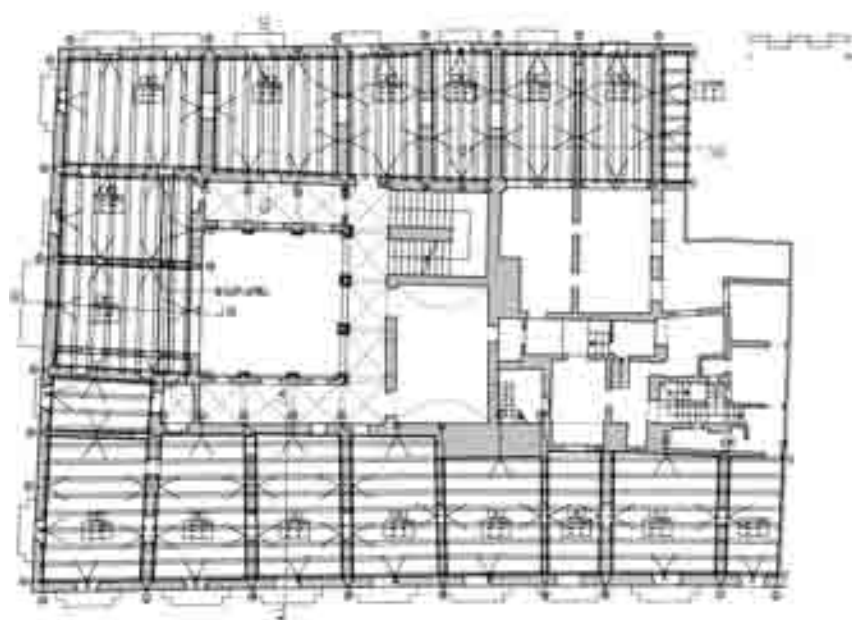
Trapani, Palazzo Riccio di San Gioacchino, schema planimetrico con indicati gli interventi sui solai.
